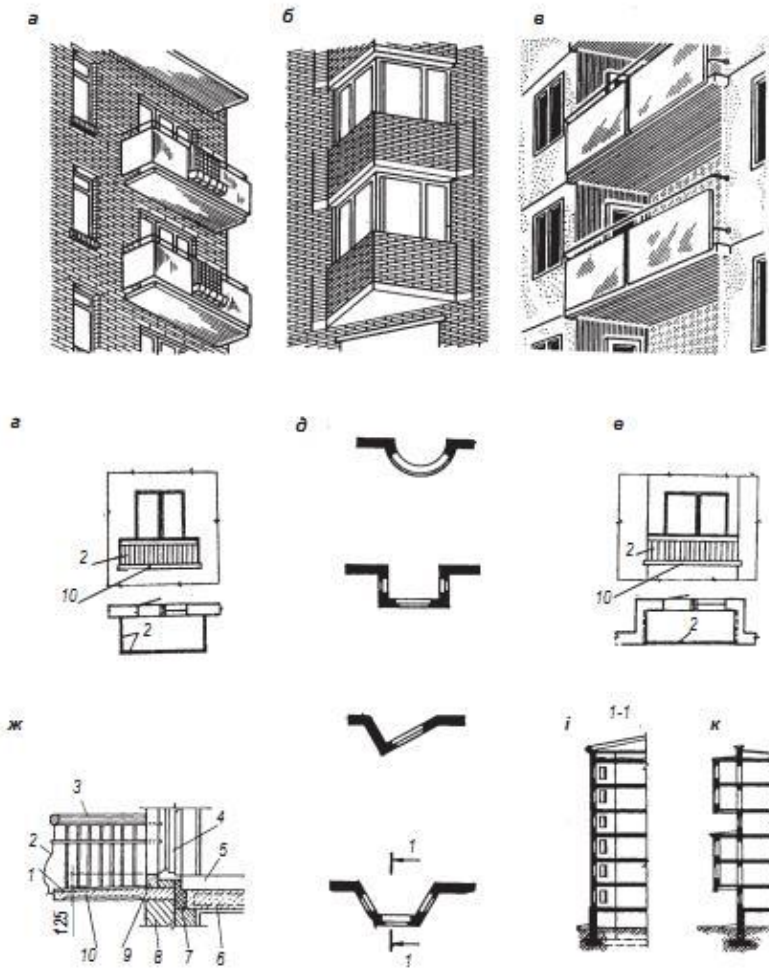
Балкони, еркери, лоджії: а - балкон; б - еркер; в - лоджія; г - фрагмент плану та фасаду балкона; д - форми еркерів; 1 - підлога балкону по гідроізоляції; 2 - огорожа балкону; 3 - поручень; 4 - двері; 5 - підлога; 6 - залізобетонна плита перекриття; 7 - теплоізоляція; 8 - стіна; 9 - збірний бетонний поріг; 10 - залізобетонна плита (лоджії)
